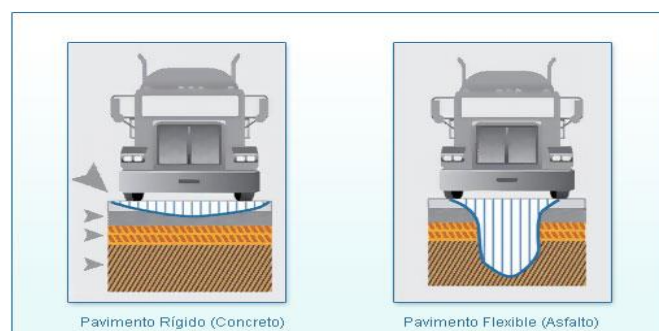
Distribución de cimentación en pavimento asfáltico y pavimento de concreto. Fuente: Elaboración propia.
